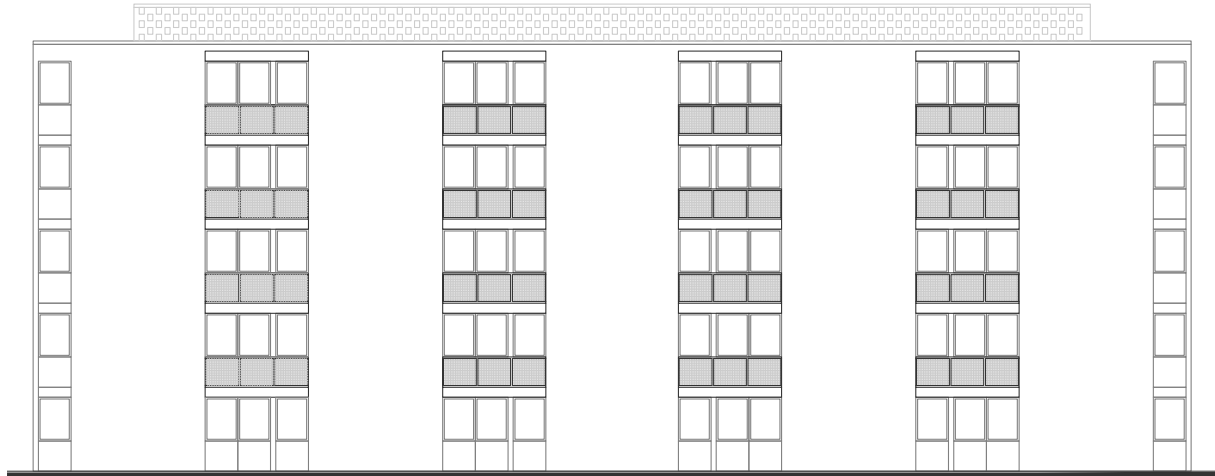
Fachada este de edificio tipo B, Fuente: Luz Pirr'on y elaboración propia
